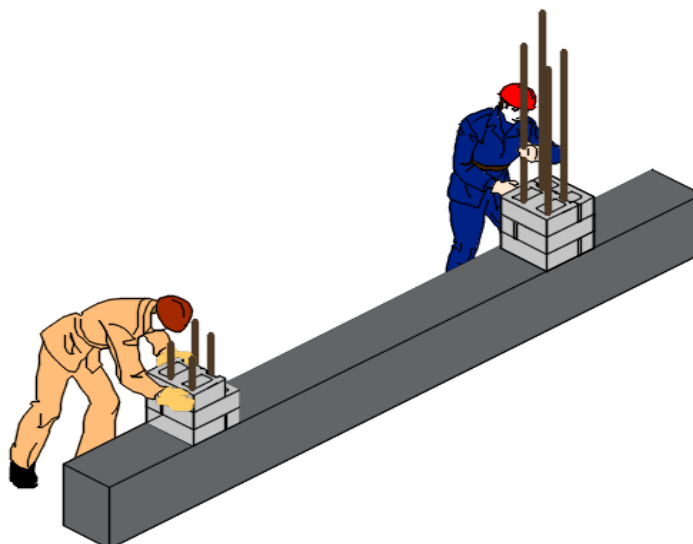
Нарращивание арматурных стержней по высоте кладки
